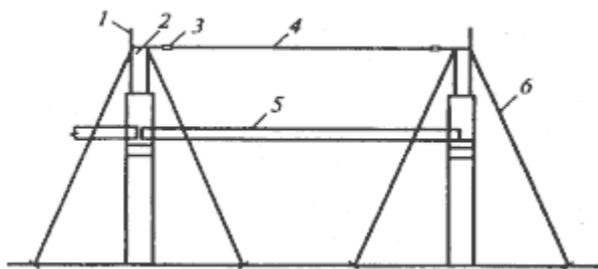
Установка и раскрепление первых двух стропильных ферм
